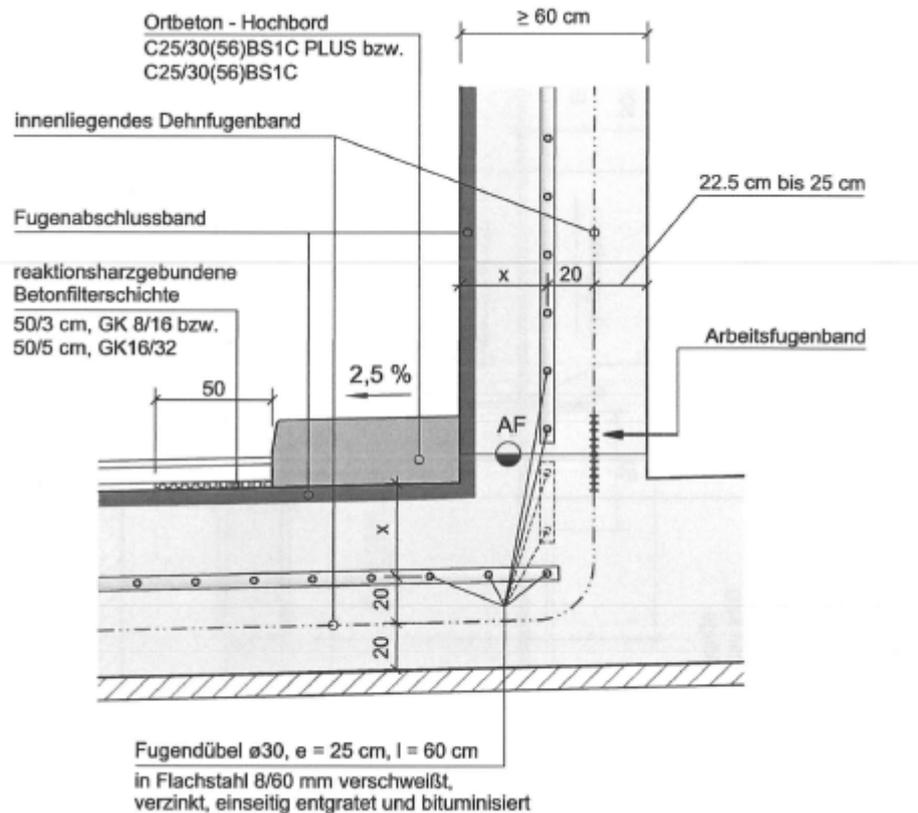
Anschluss Bodenplatte zu Wand [63]
